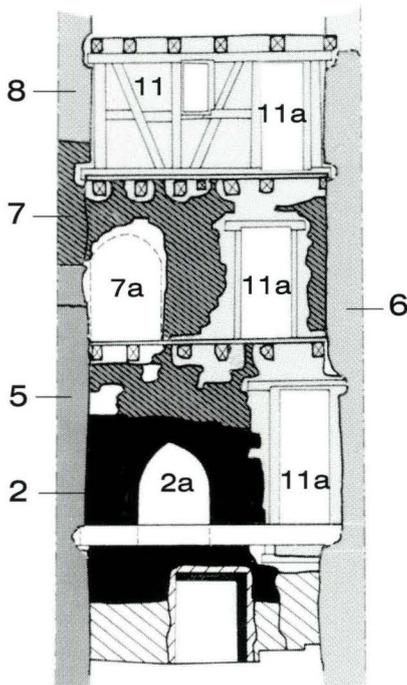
Webergasse 3. Ansicht der Kernbau-Vorderfassade (heute Quermauer) mit den baugeschichtlichen Befunden. – Umzeichnung: Stephan Tramèr und Hans Ritzmann. – Massstab 1:100.
